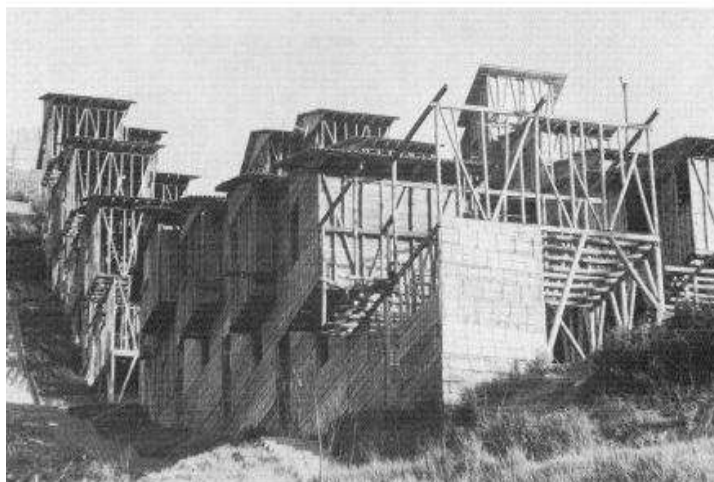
sistema constructivo bahareque encementado posmoderno. Barrio Malhabar II
